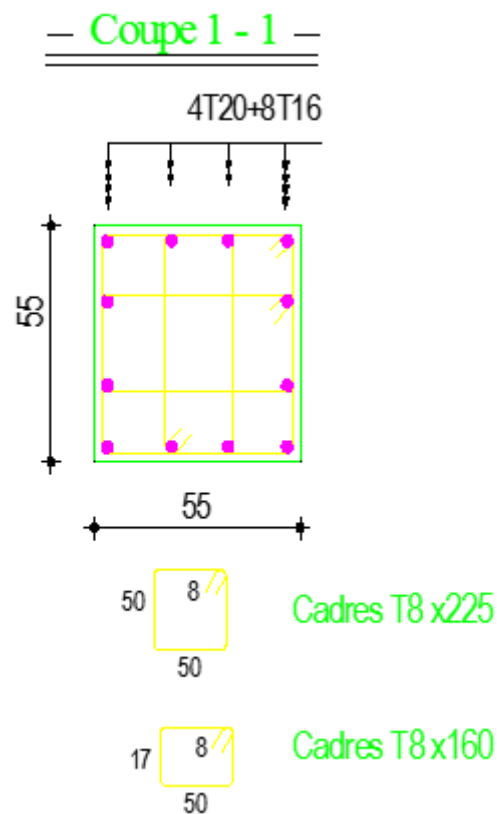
Exemple de ferrailage d'un poteau (55×55)
